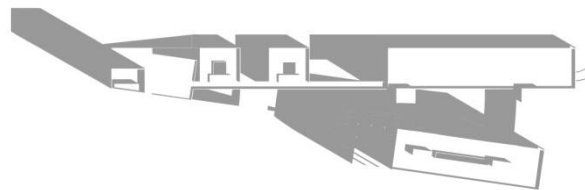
PLANTA COBERTURA INTERVENÇÃO
